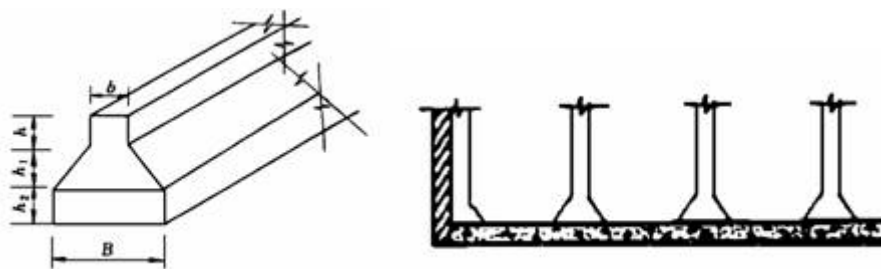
混凝土条形基础示意图 图 5.38 无梁式满堂基础示意图
